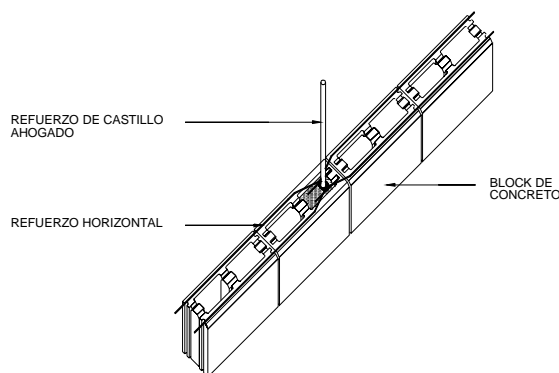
Anclaje intermedio de refuerzo horizontal
